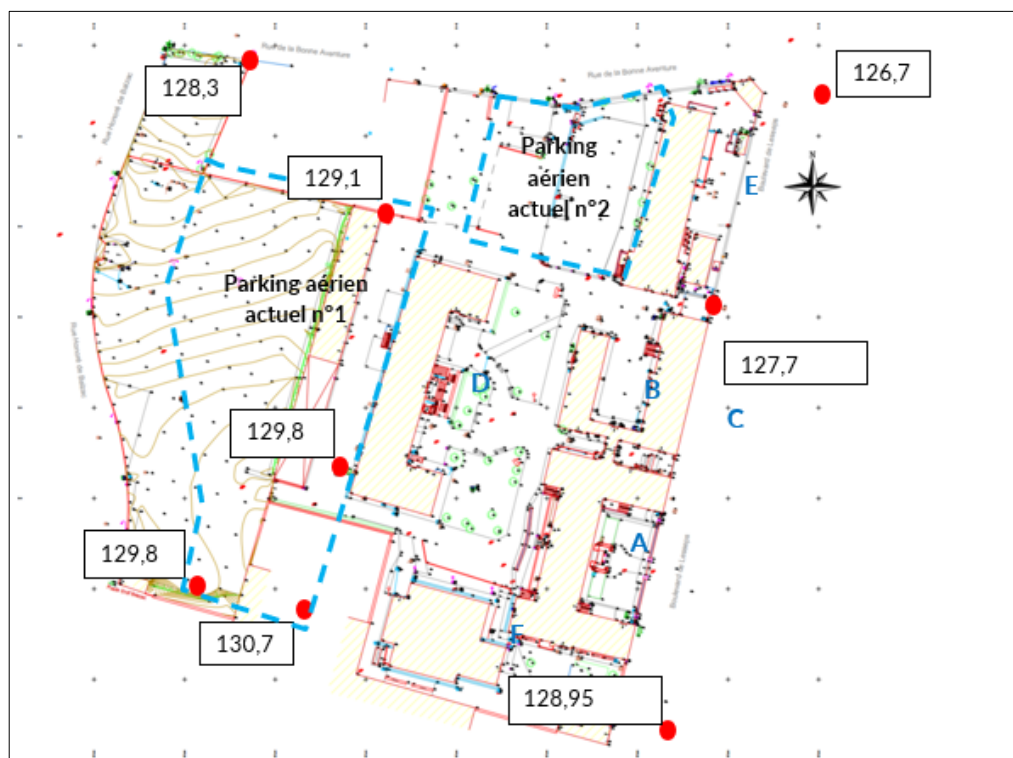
Extrait du plan topographique du site (Source : BEP Ingénierie)
